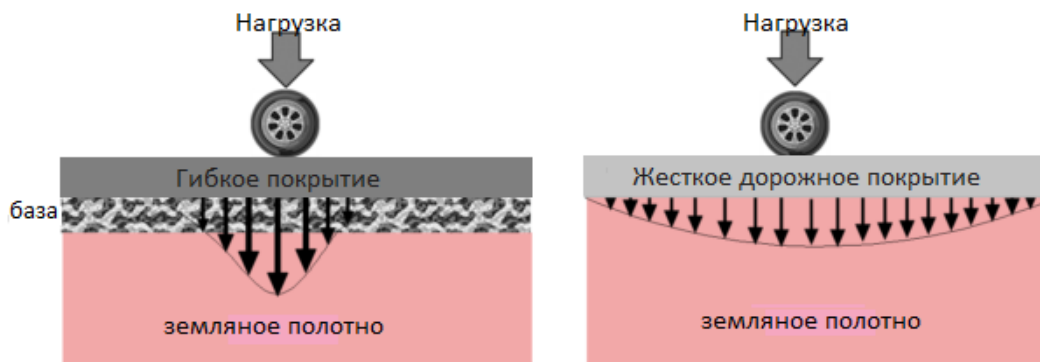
Действия автотранспортной нагрузки на асфальтобетонные и цементобетонные покрытия
